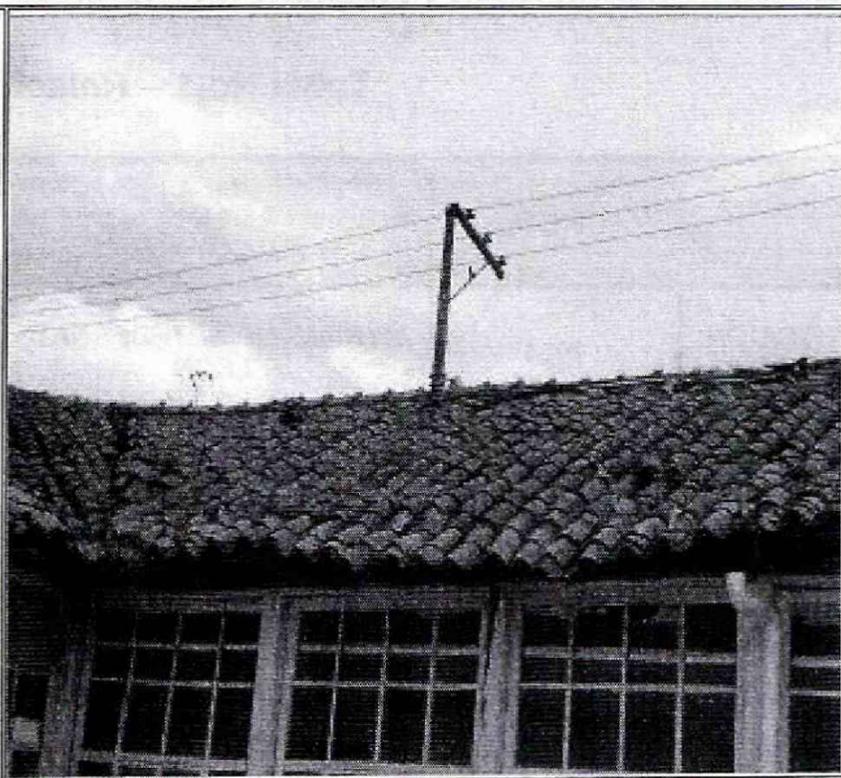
Hundimiento de la estructura de cubierta de "La Casona"
